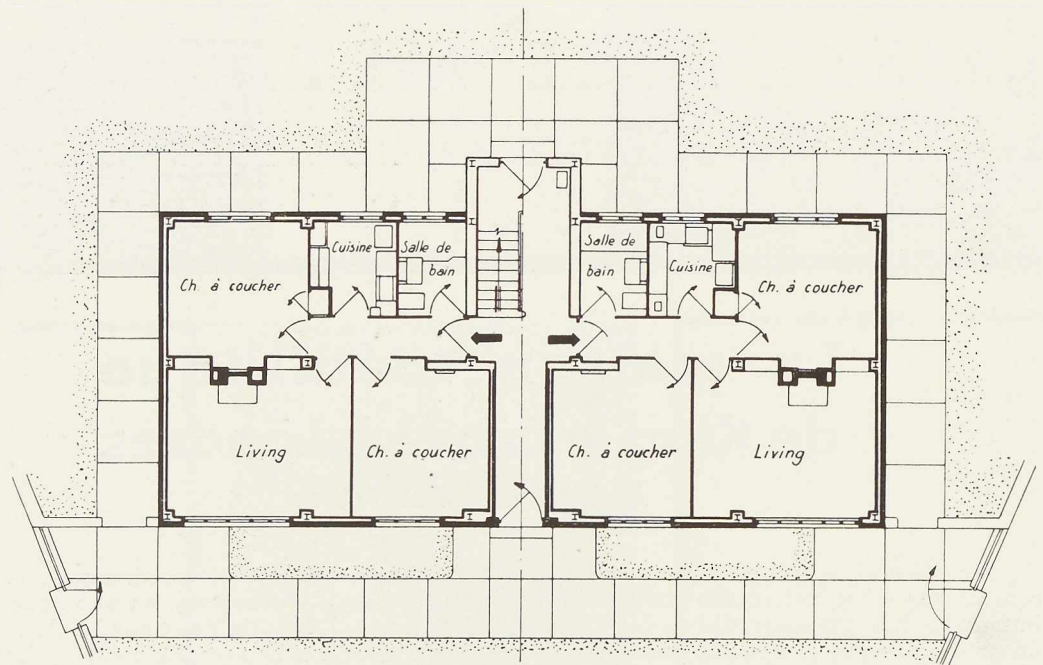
Plan du rez-de-chaussée de la maison de King's Cross.
